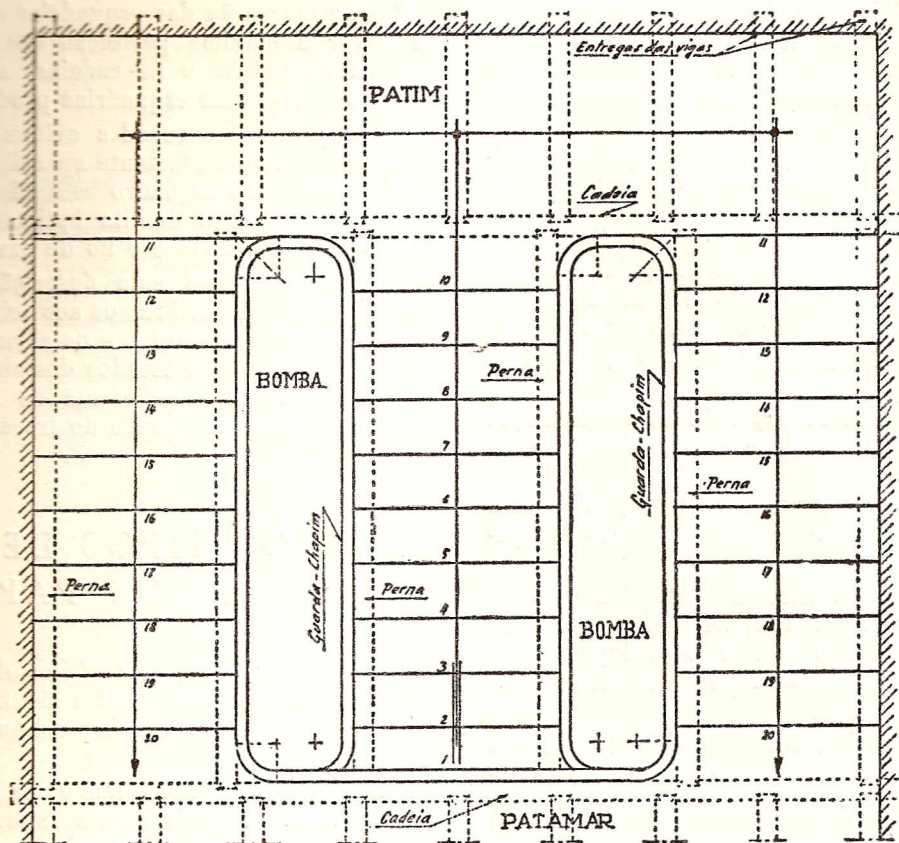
PLANTA DA ESTRUTURA E DOS LANÇOS DA ESCADA
